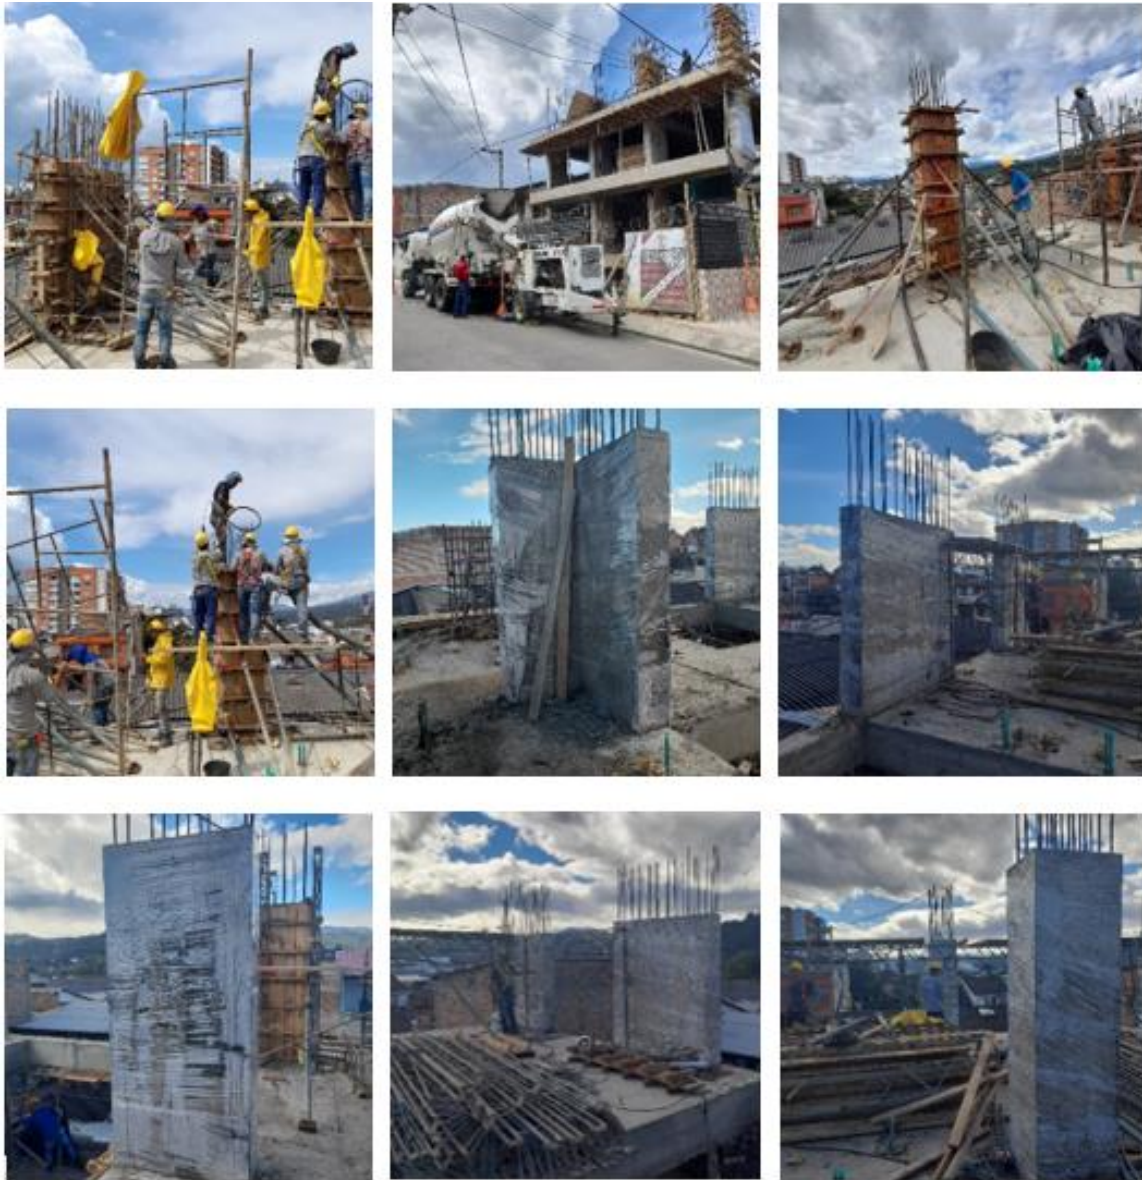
Armado, encofrado de elementos estructurales verticales sobre la losa del nivel N+8,46.
